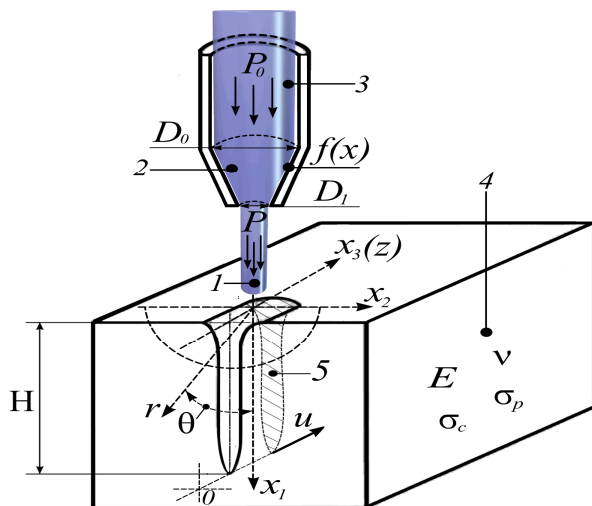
Расчетная схема гидрорезания поверхности цементобетонного или асфальтобетонного покрытия:
